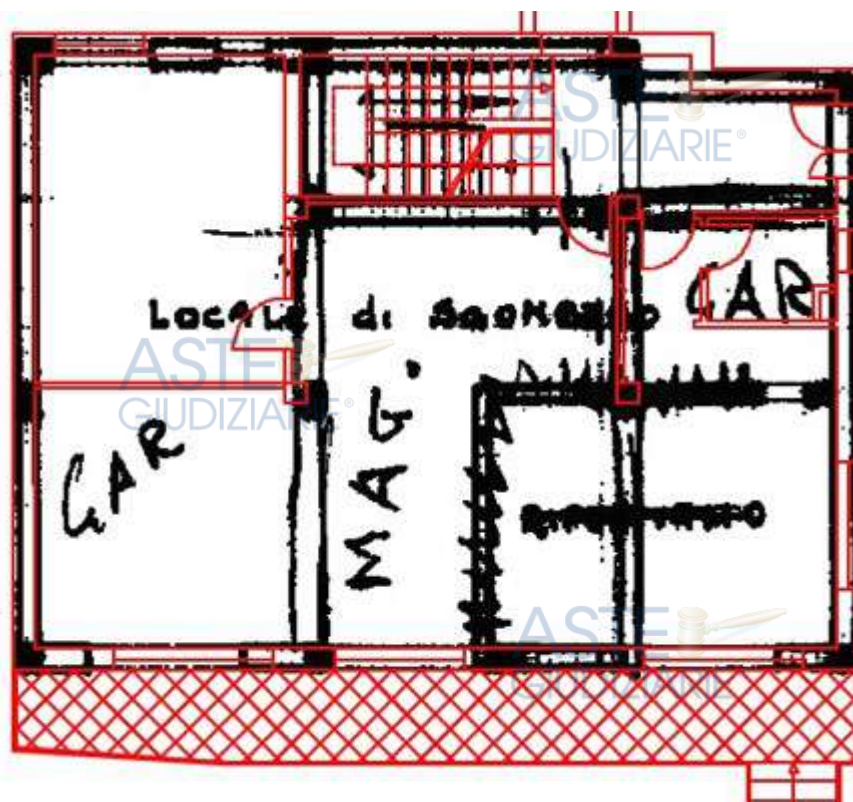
Stralcio planimetria catastale imm. 2 (negozi). Sovrapposizione con rilievo. Fuori scala, nord a destra.
